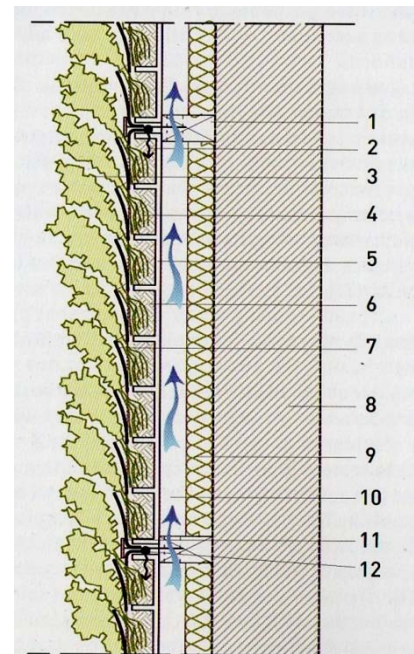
Corte explicativo de uma Parede Viva de Substrato ligeiro:
